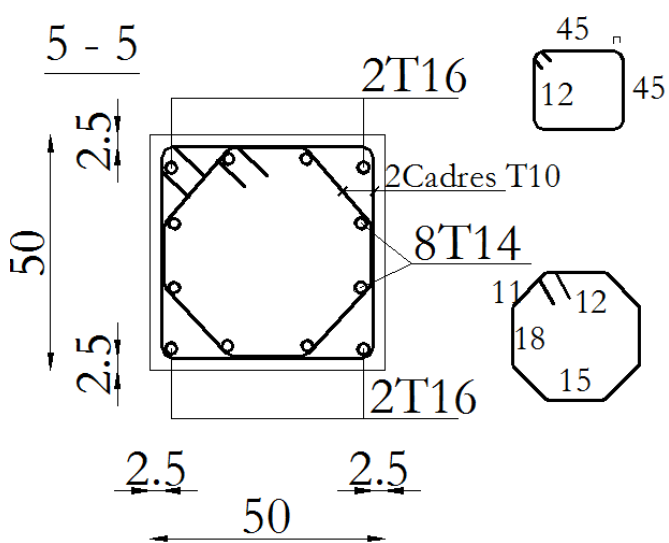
Ferrailage des poteaux 6<sup>ème</sup> et 7<sup>ème</sup> étage
